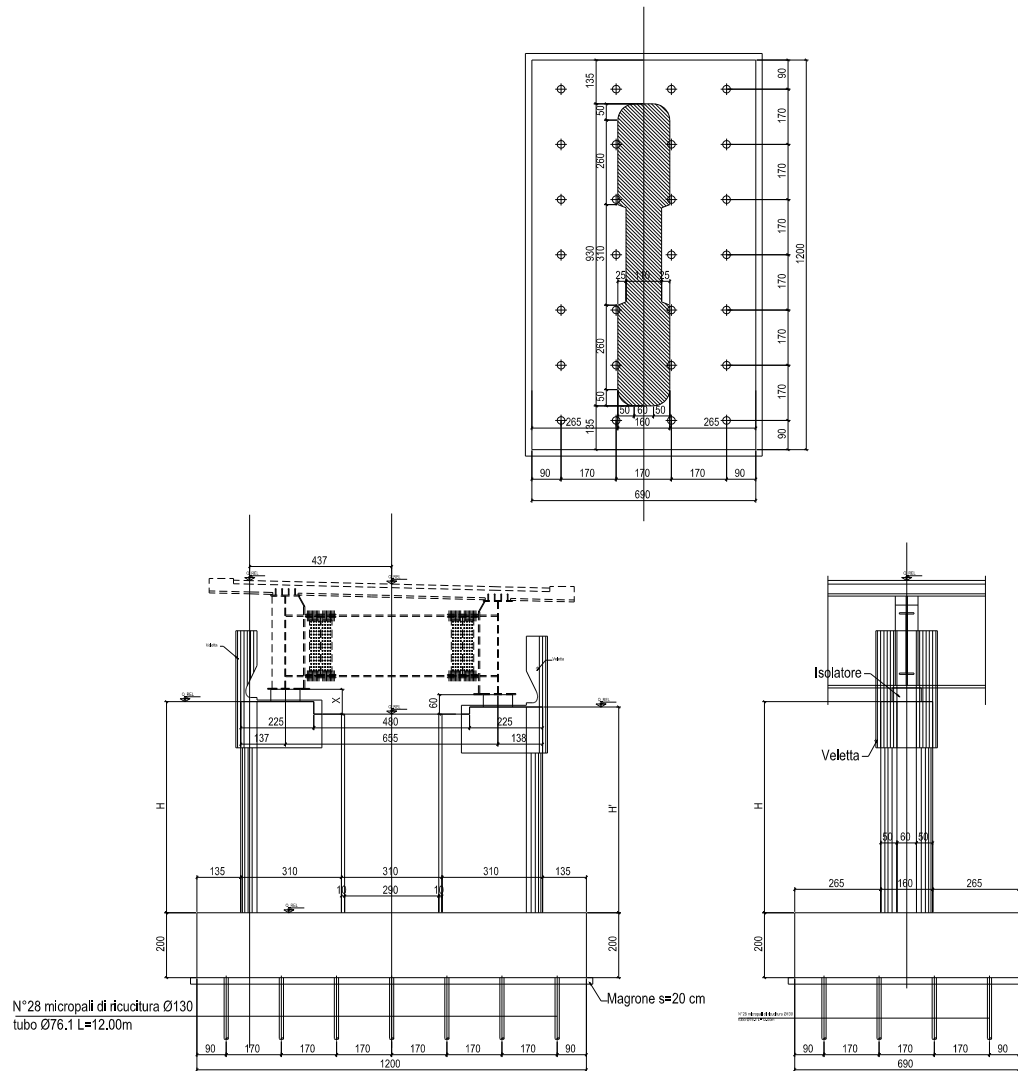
Sezione trasversale, vista trasversale e longitudinale delle pile 3 e 4
